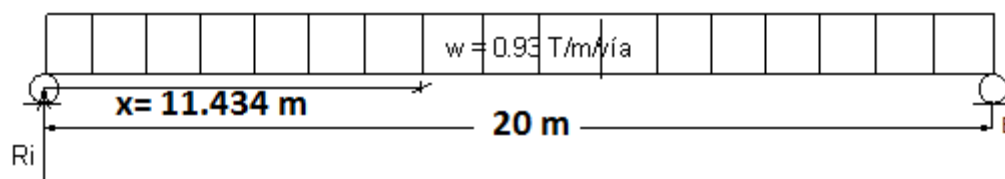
Carga equivalente para el apoyo fijo. Elaborado por: Autor
